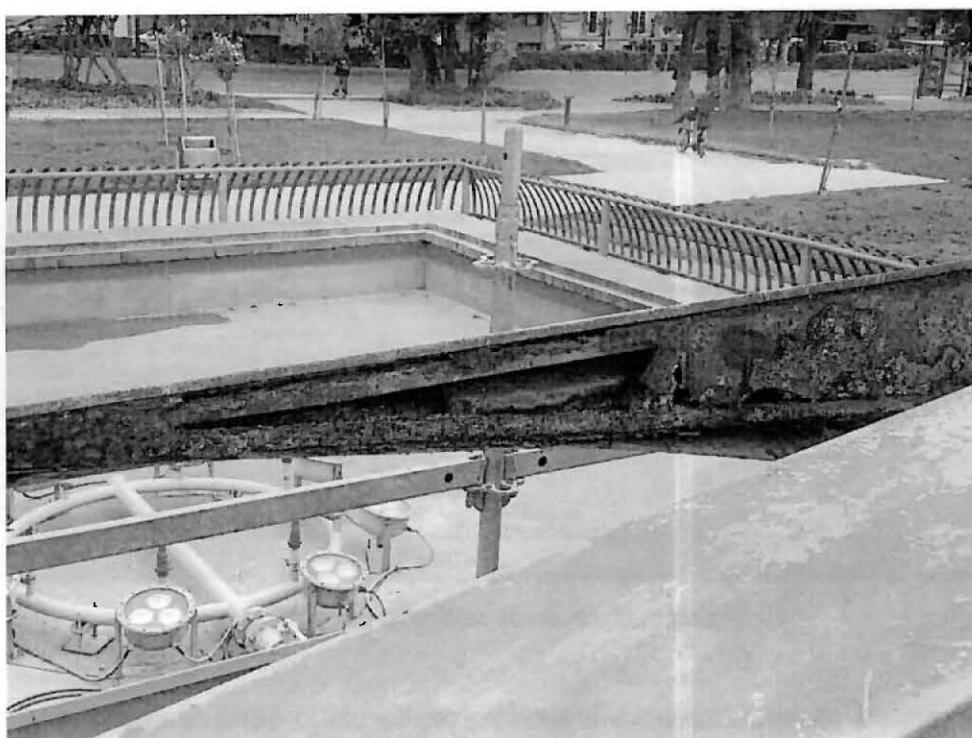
Oxidación en cola del monumento, se ha consumido la plancha de acero de cierre de la estructura de viga reticulada.
